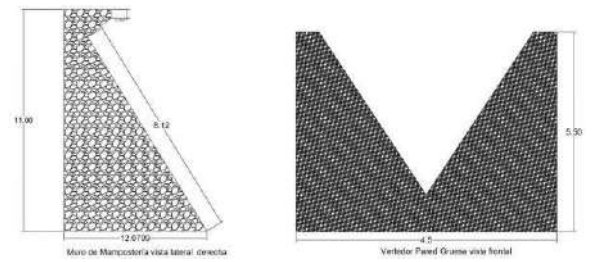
Vistas planas laterales y frontal principales del diseño, AUTOCAD
